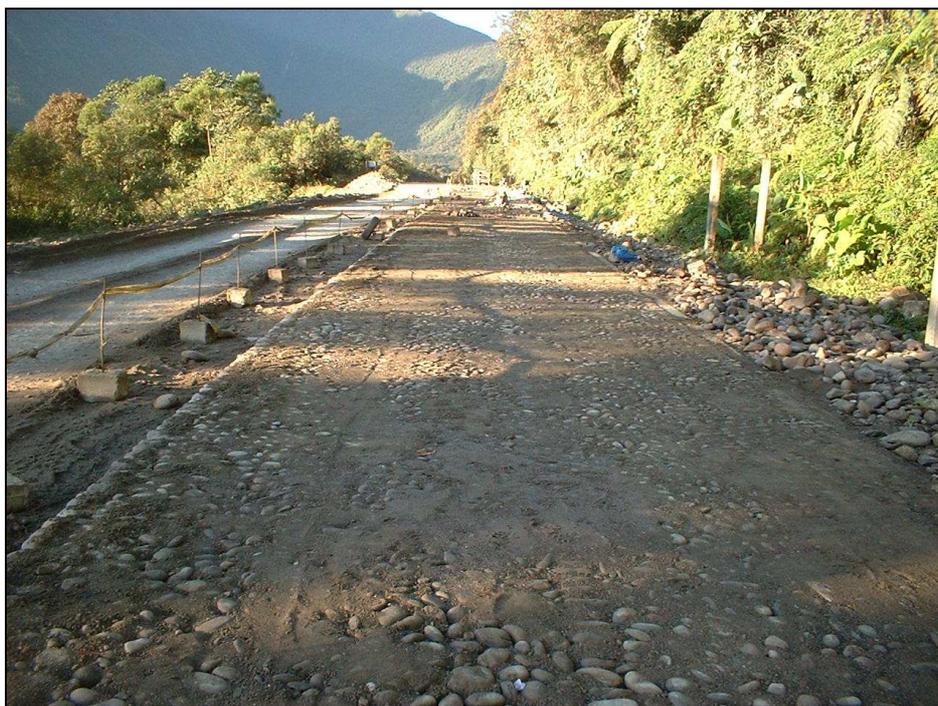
Colocación e Hincado de Piedra en Empedrado
